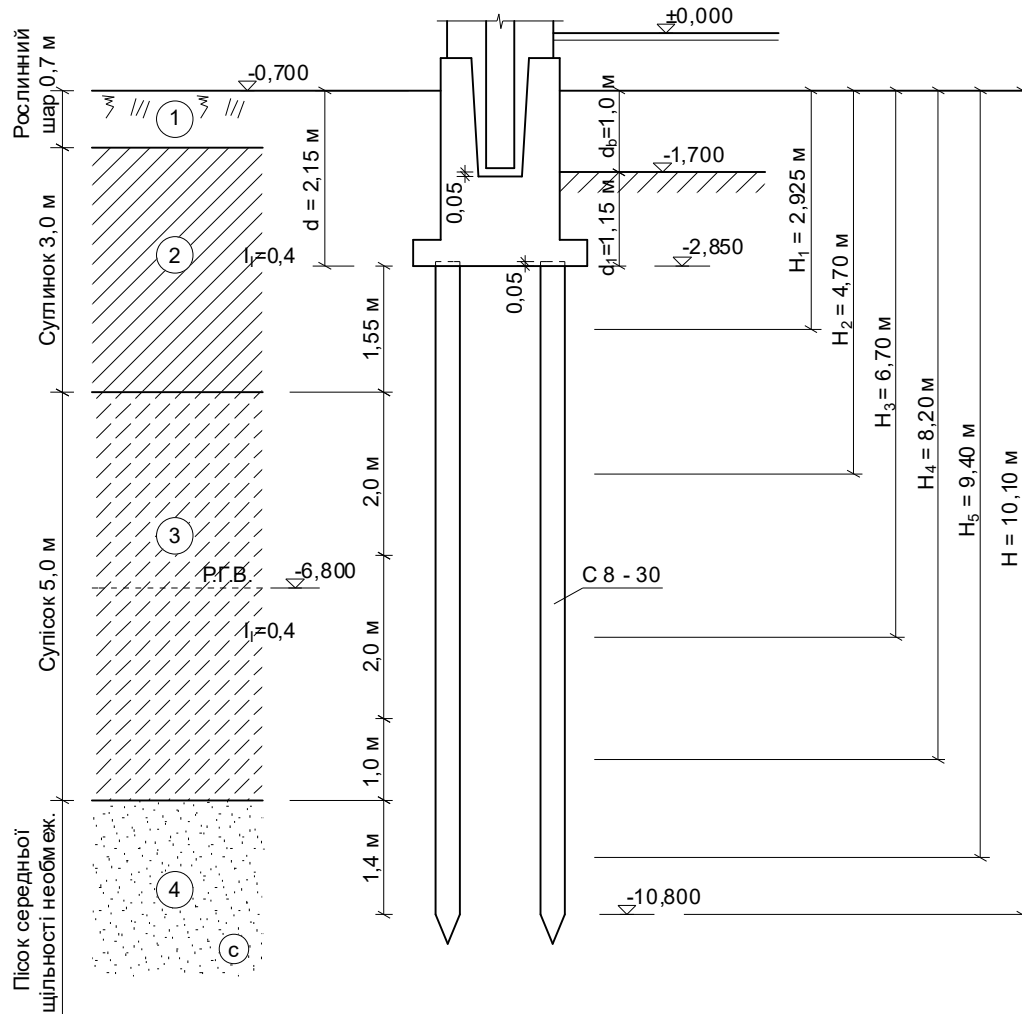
Розміщення паль у ґрунті і параметри, необхідні для розрахунку
